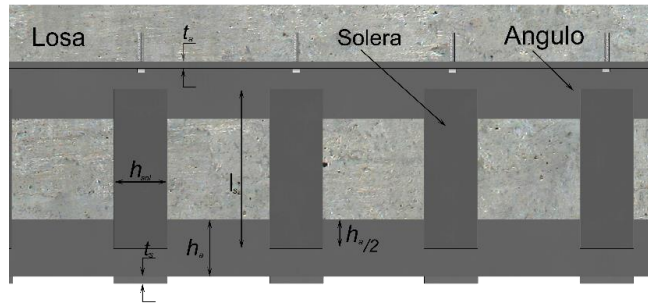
b - Sección longitudinal de viga encamisada con ángulos y soleras
